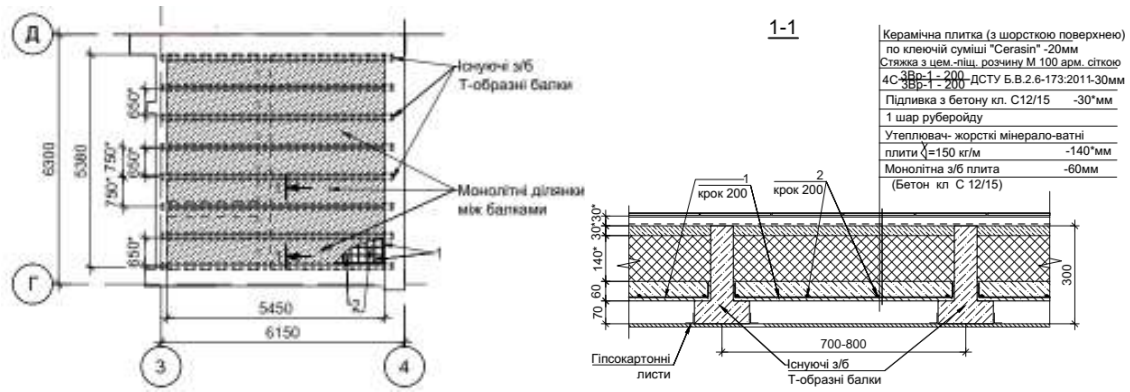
Фрагмент плану перекидання 1-го поверху
